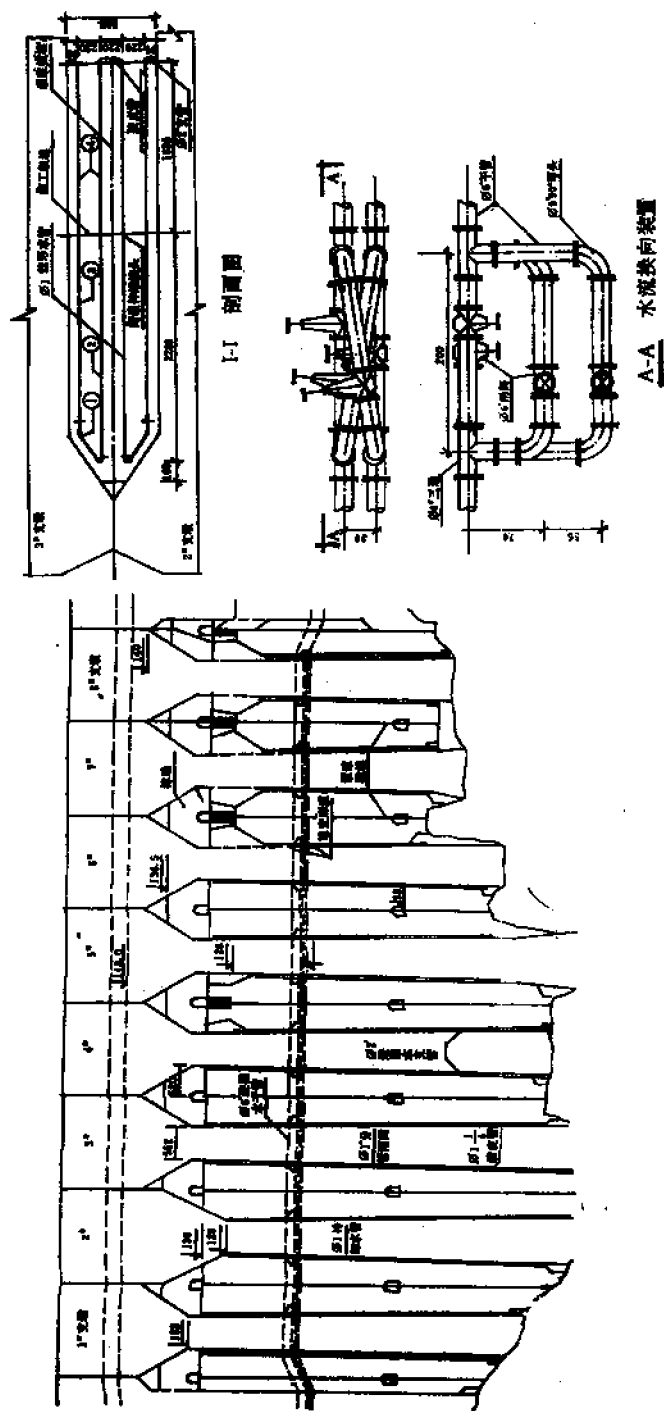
(10)b 混凝土加固体内冷却水管系统布置图
